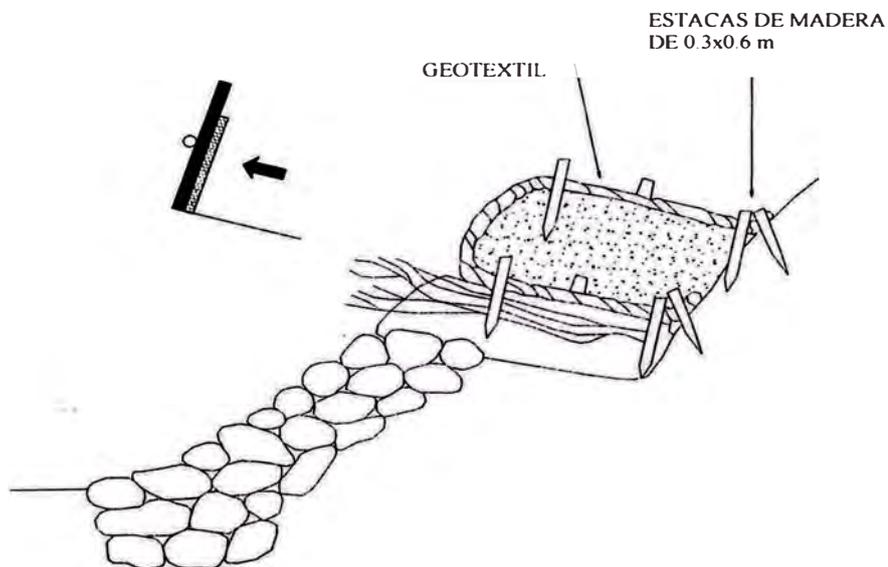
(e): Estructura de tierra reforzada – Proceso Constructivo
